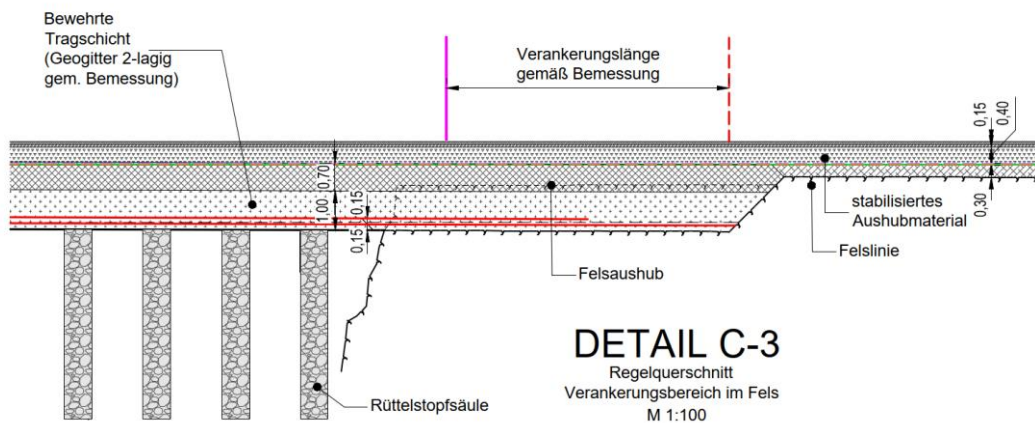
Bewehrte Tragschicht (Ausschnitt aus Plan [P11])
